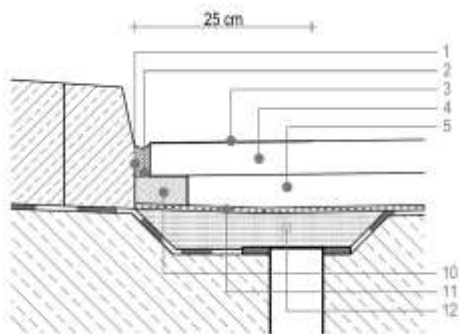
Detalj obrade spoja uz ivičnjak
